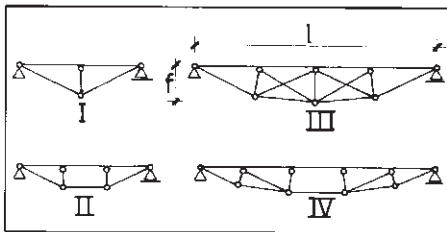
Mögliche statische Systeme: einfach bis vierfach unterspannte Träger
